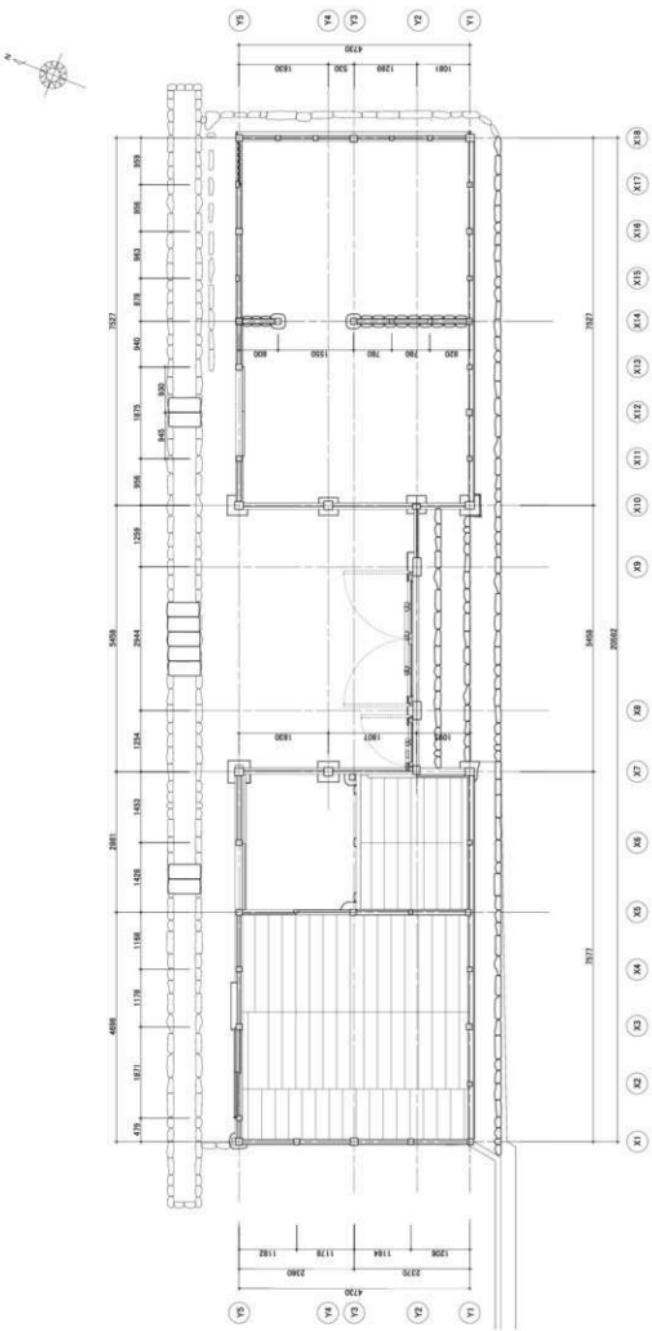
長屋門 建工 1階平面図 S=1/100
